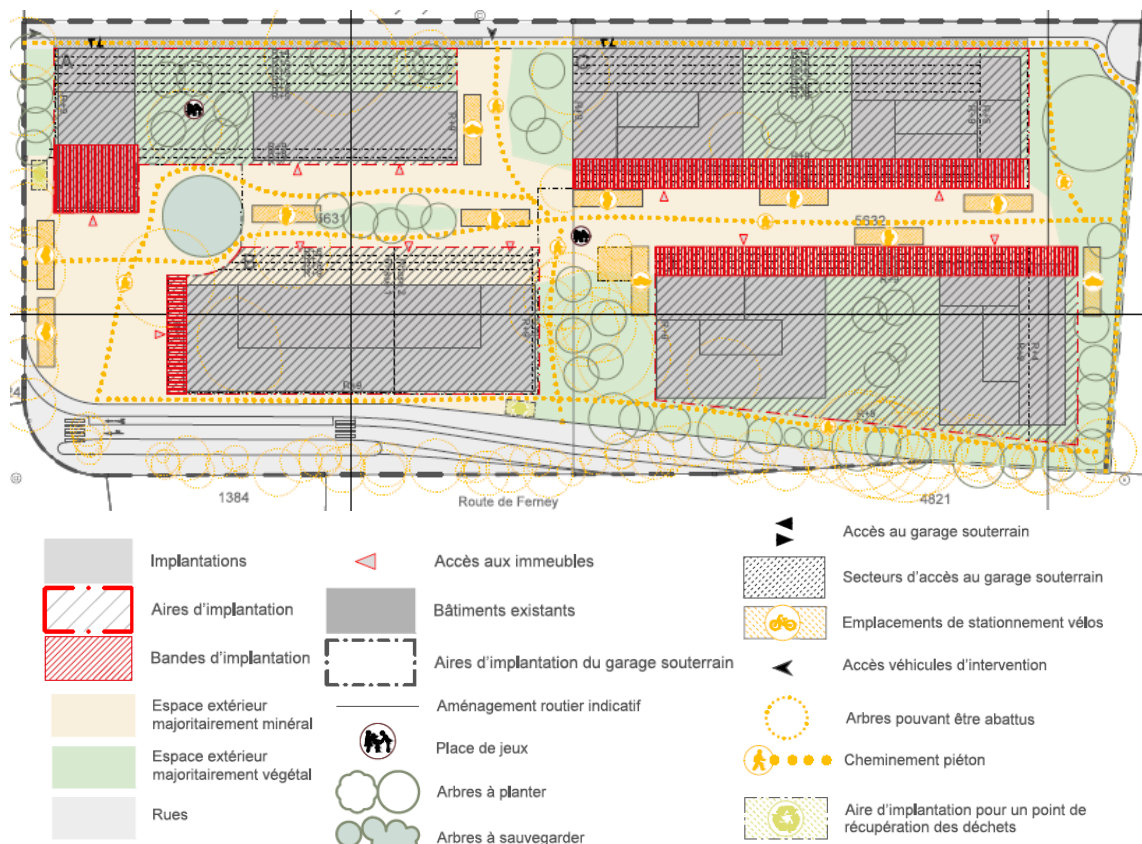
Plan de principe provisoire de l'implantation des bâtiments (Source : Urbaplan)
